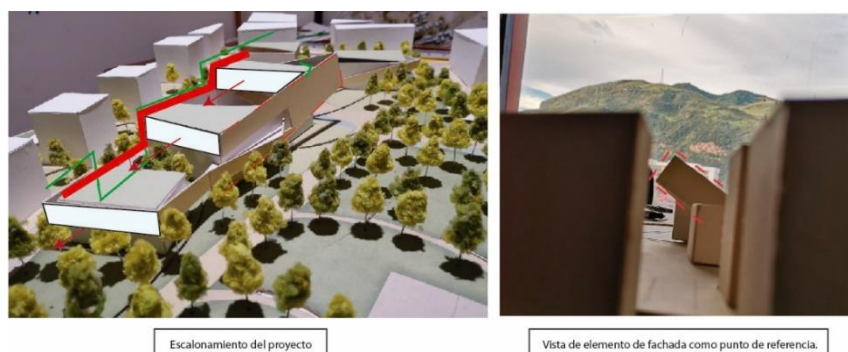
Propuesta Implantación de Bloques del Centro de Entrenamiento Deportivo.
